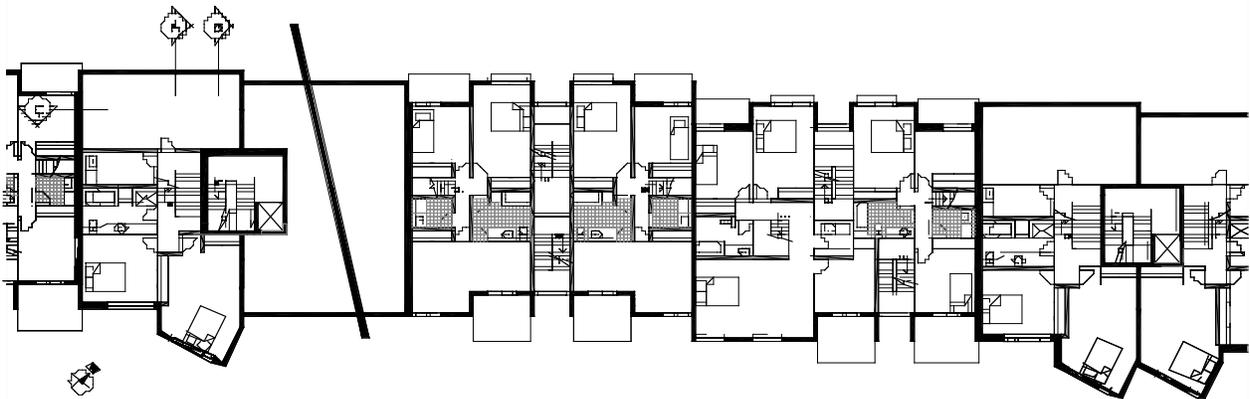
Plan du sous-sol d'un walk-up rénové et réaménagé.
